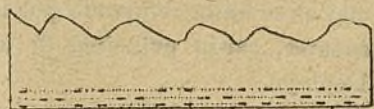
Chapa colocada de plano, con indicación de las tirillas alternadas.
